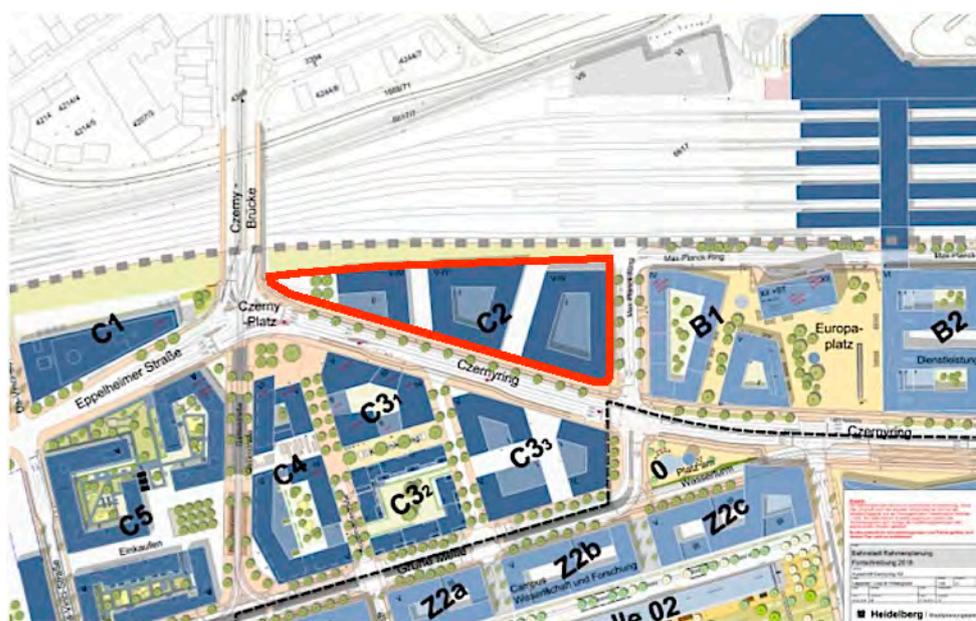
Rahmenplan Baufeld C2, Stand: 06.08.2019 (Quelle: Stadt Heidelberg, Stadtplanungsamt)
